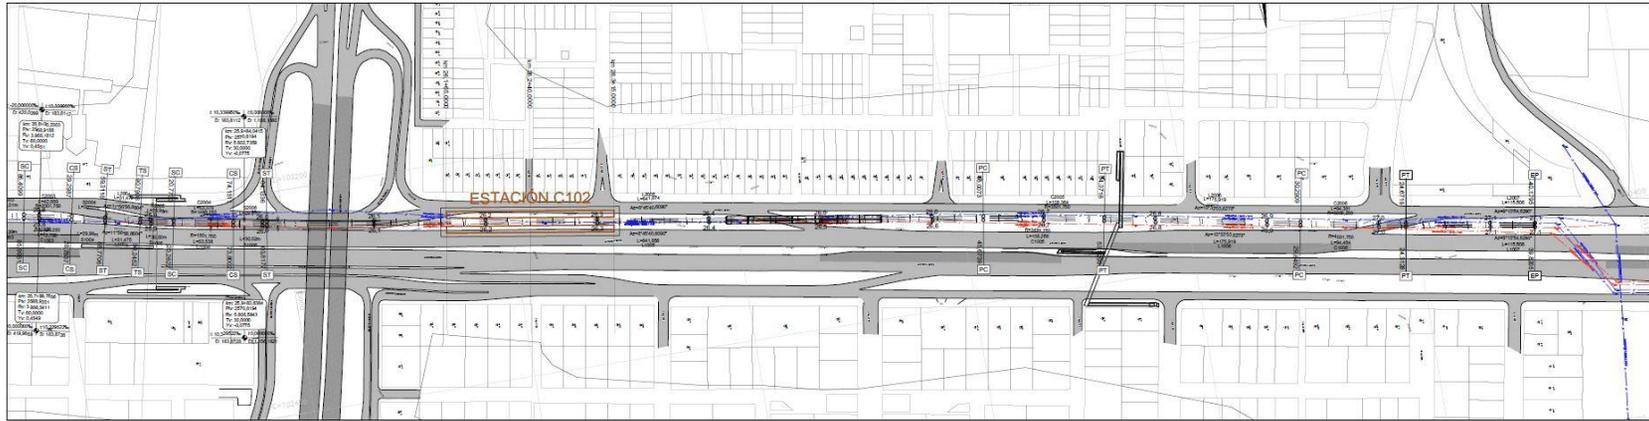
18 - Perfil longitudinal del trazado extensi3n PLMB-Tramo1, Tramo "nodo calle 92"-calle 100 Sur – Vía 2
